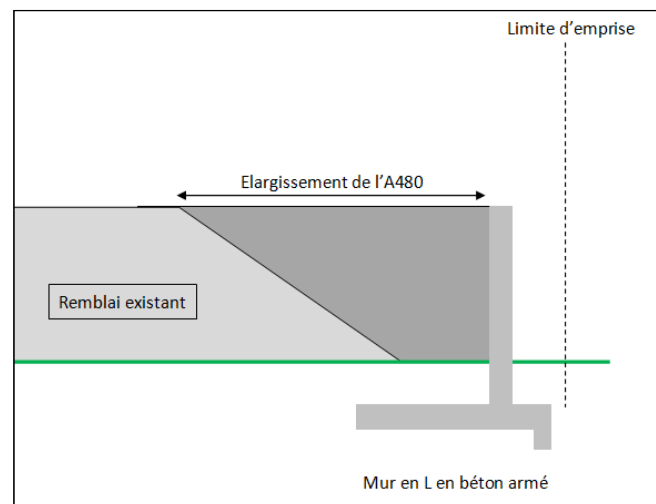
Exemple d'un élargissement nécessitant un soutènement.
